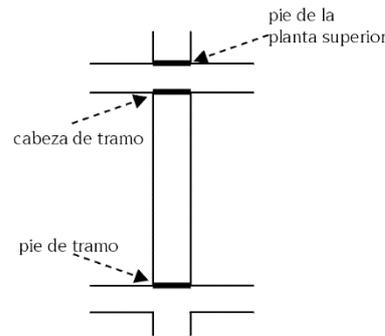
SECCIONES QUE SE COMPRUEBAN EN UNA PLANTA
